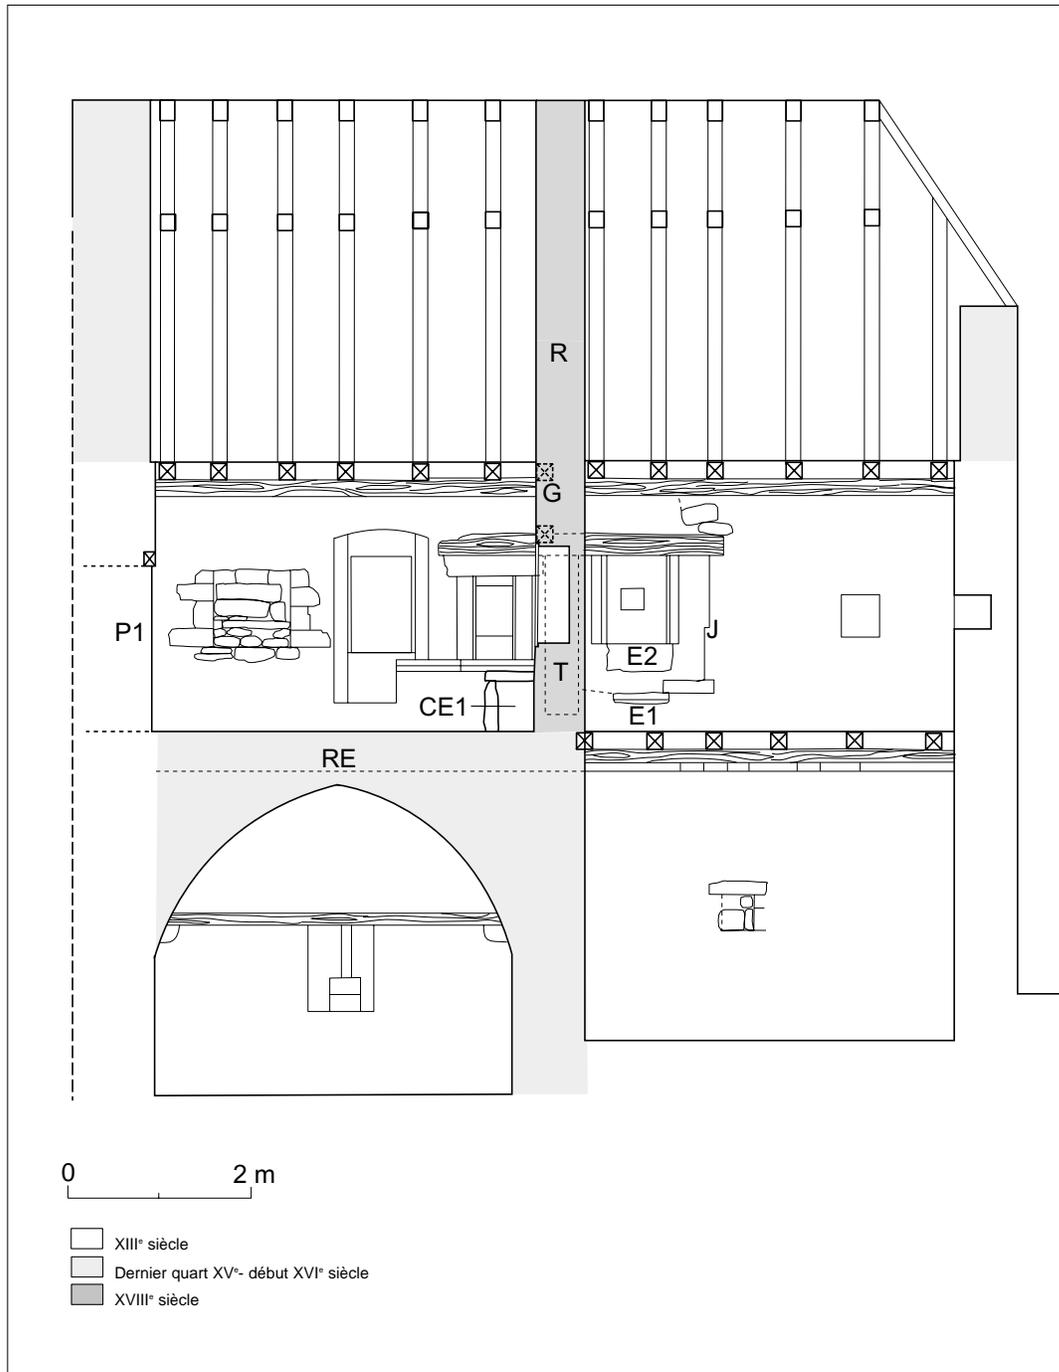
MAISONS JUMELLES N° 1. Coupe longitudinale BB sur le revers de la façade est. Relevé V. Rousset, 2001.
